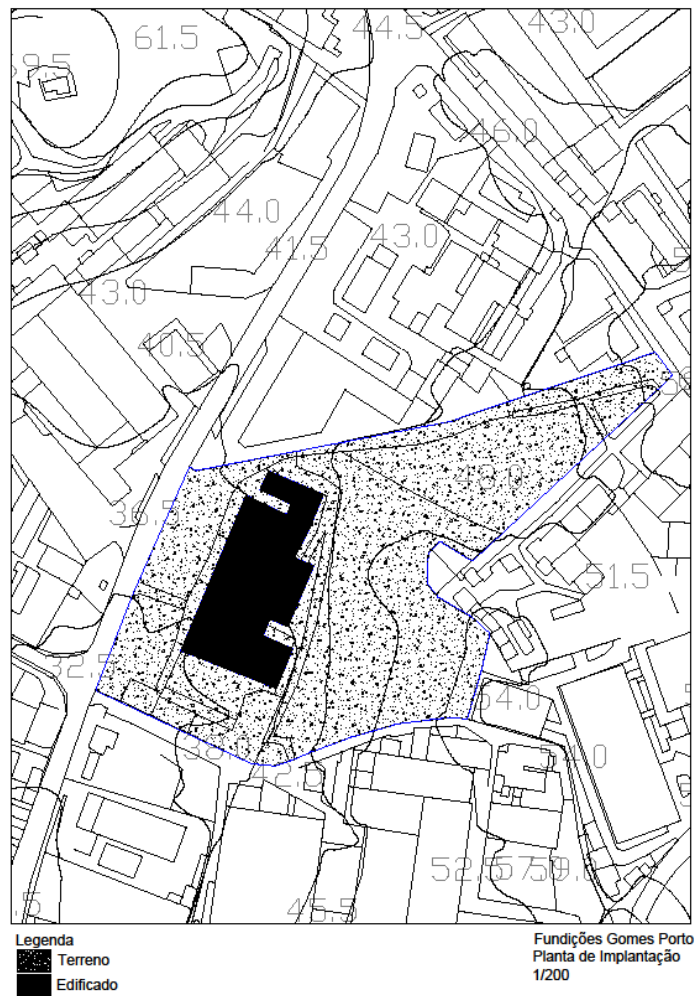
Planta de implantação da edificação e terreno envolvente da antiga fundição
